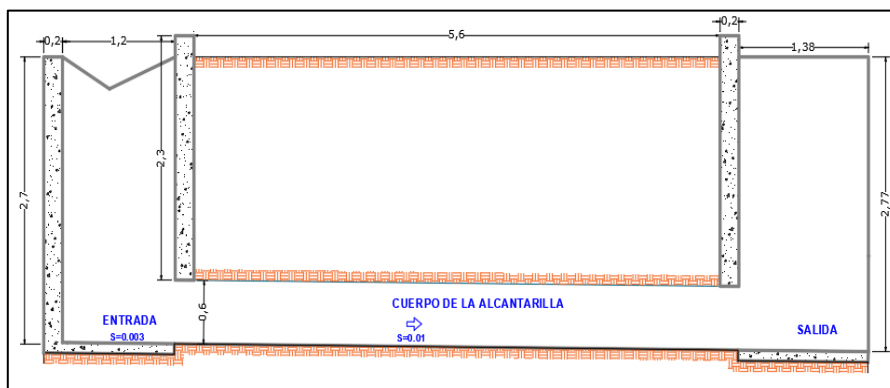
Vista en perfil de la alcantarilla N°03 existente.
